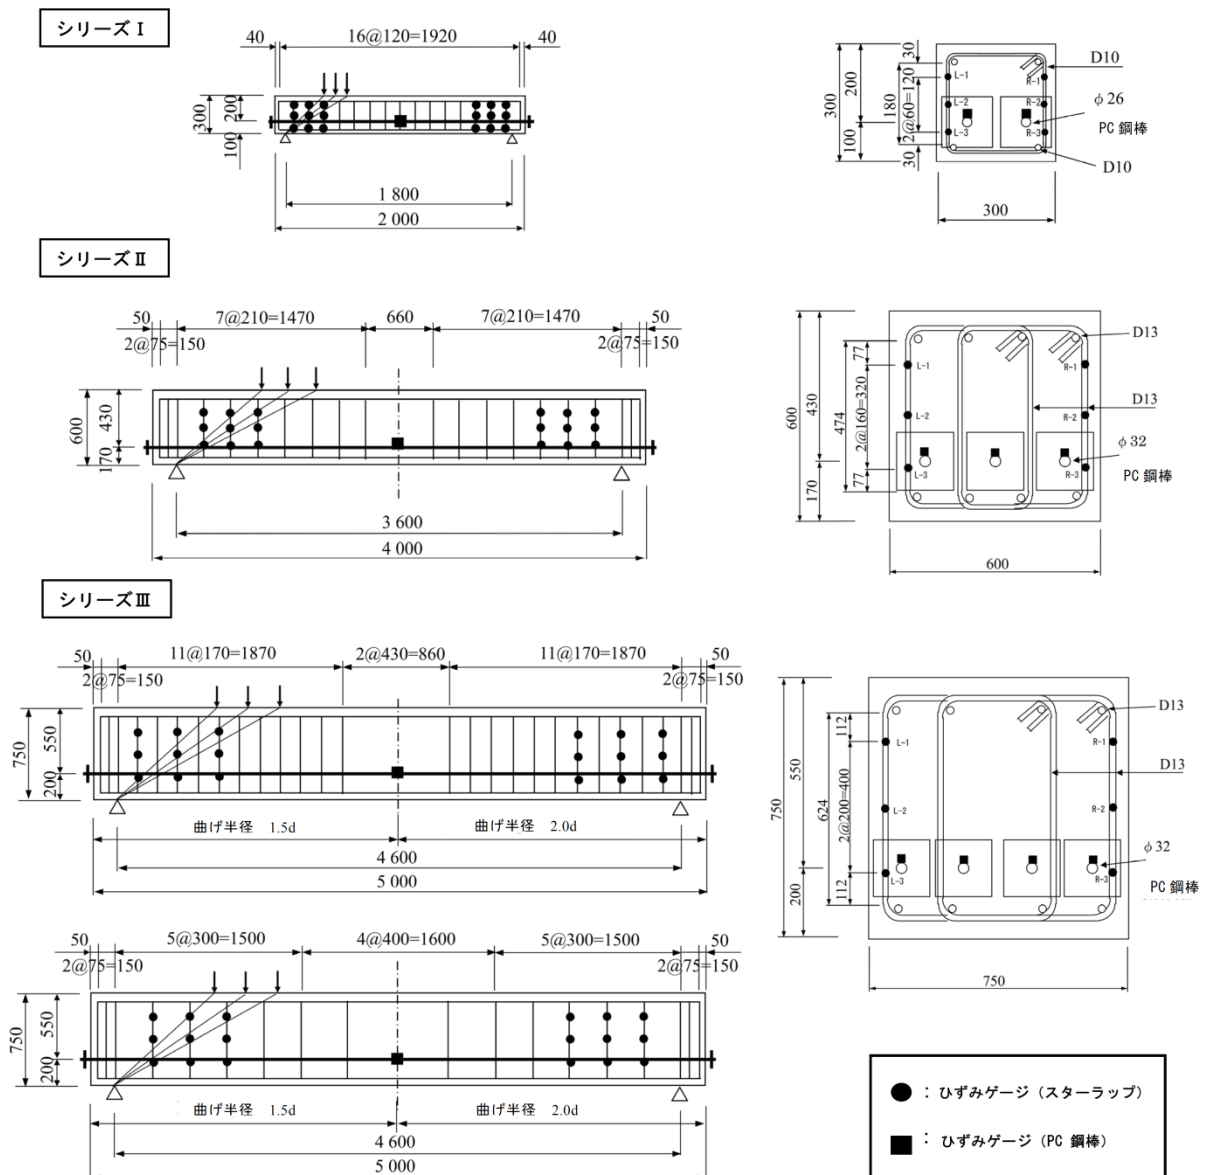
供試体形状とひずみゲージ配置 (単位: mm)
